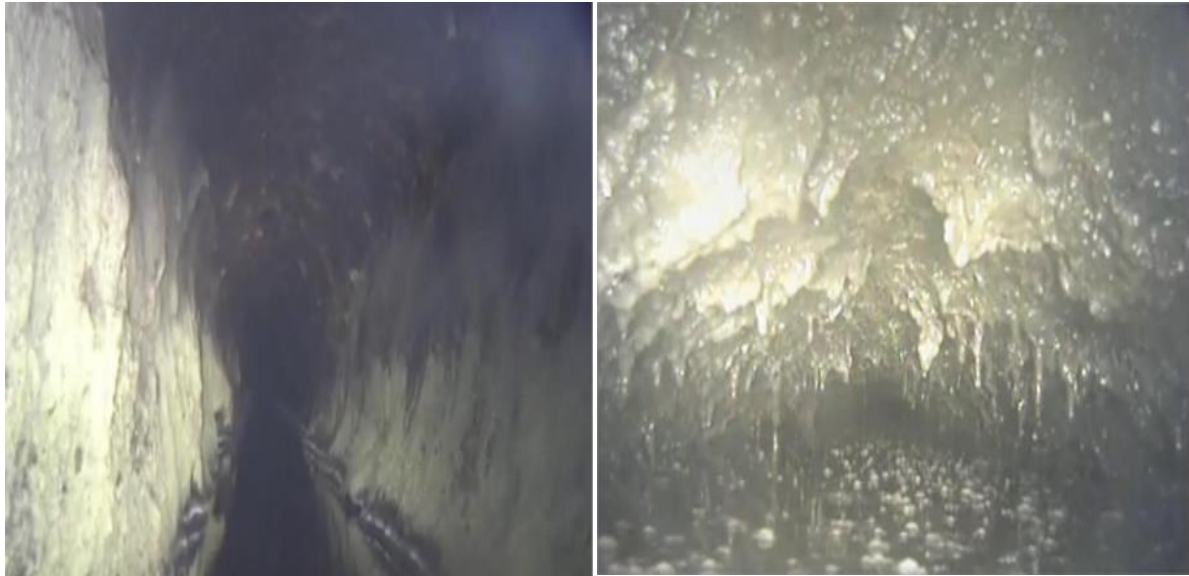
Inspection par caméra d'une conduite en béton DN400 raccordée dans l'Ovoïde
